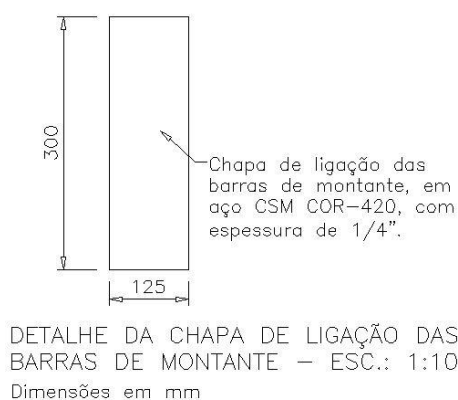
Detalhe da chapa de ligação das barras de montante.
